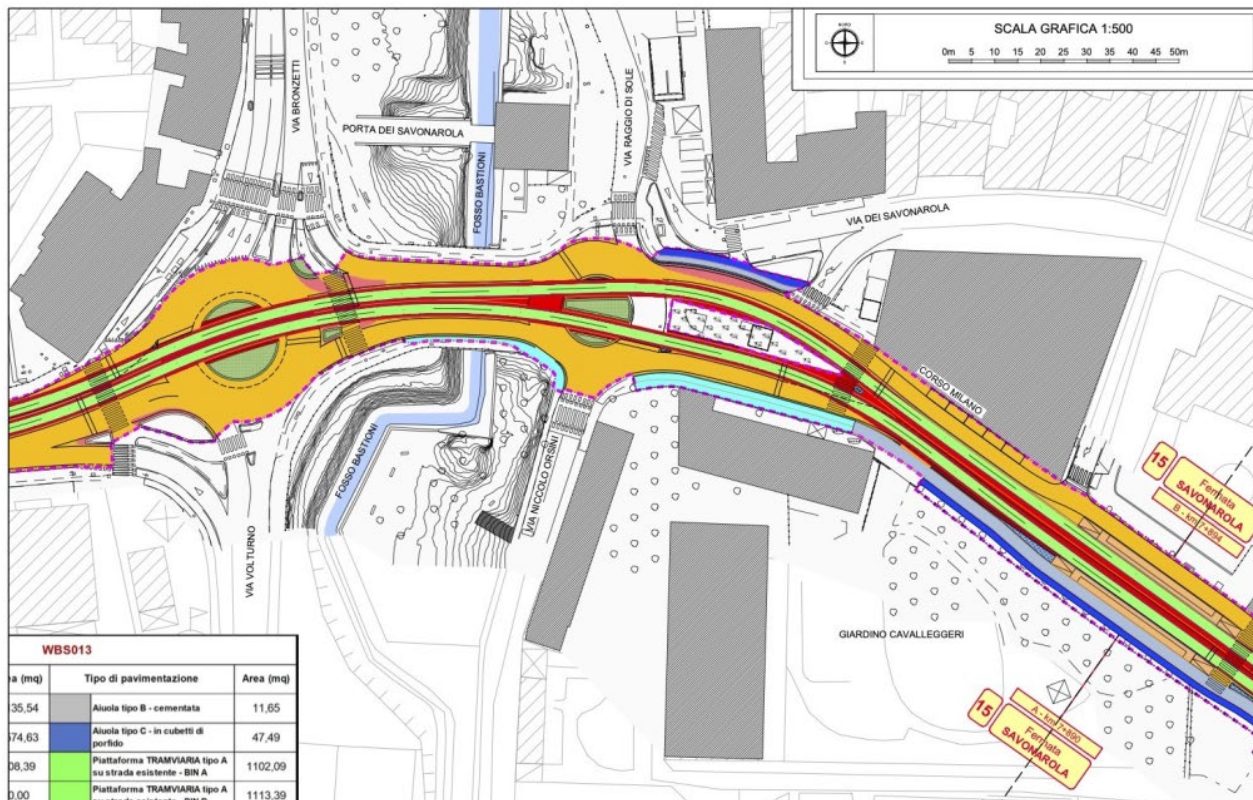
Estratto del progetto esecutivo della linea SIR2.
